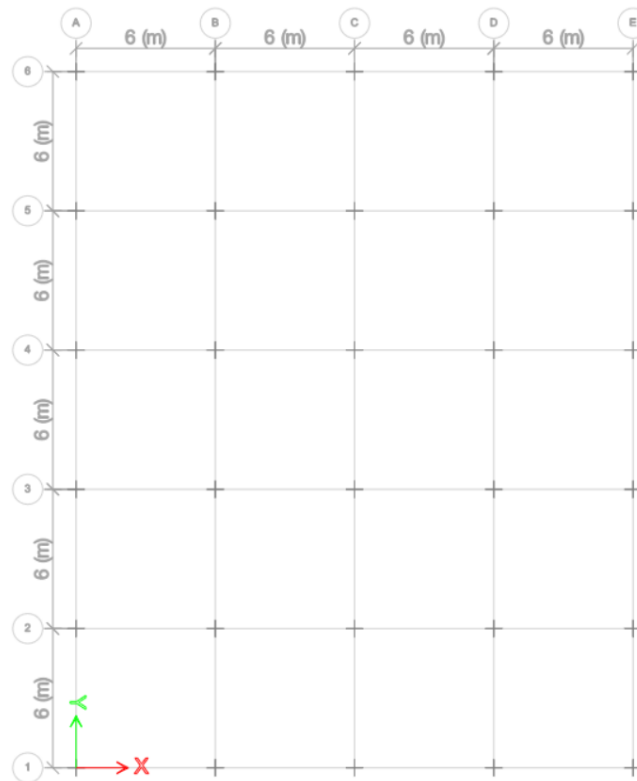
Vista en planta de la geometría de la estructura de análisis.
